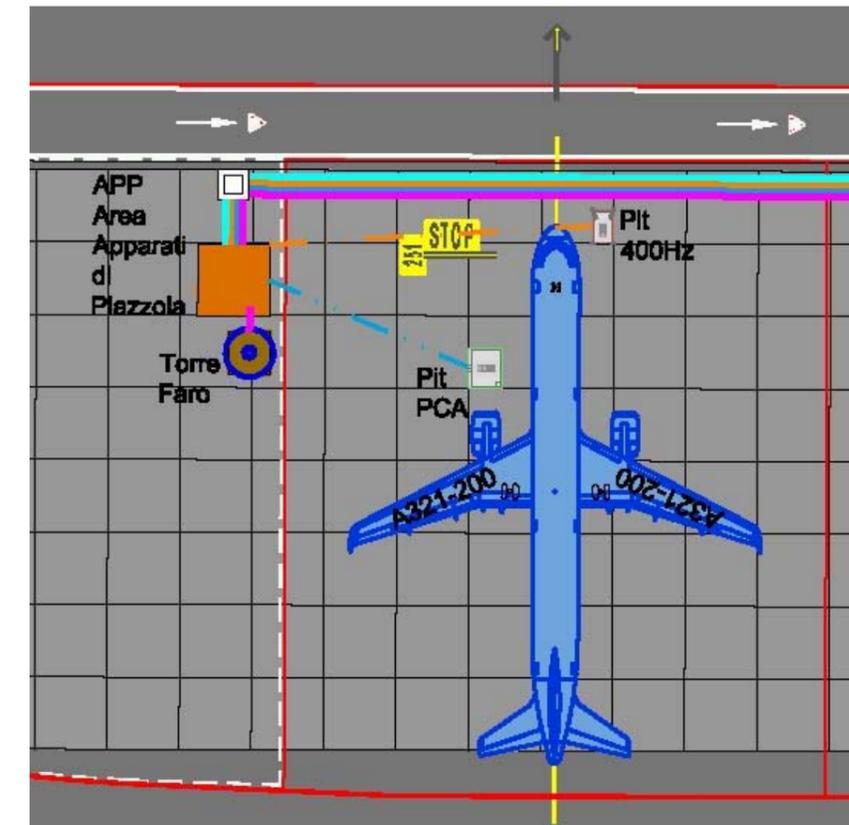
Disposizione in pianta degli apparati di Piazzola
